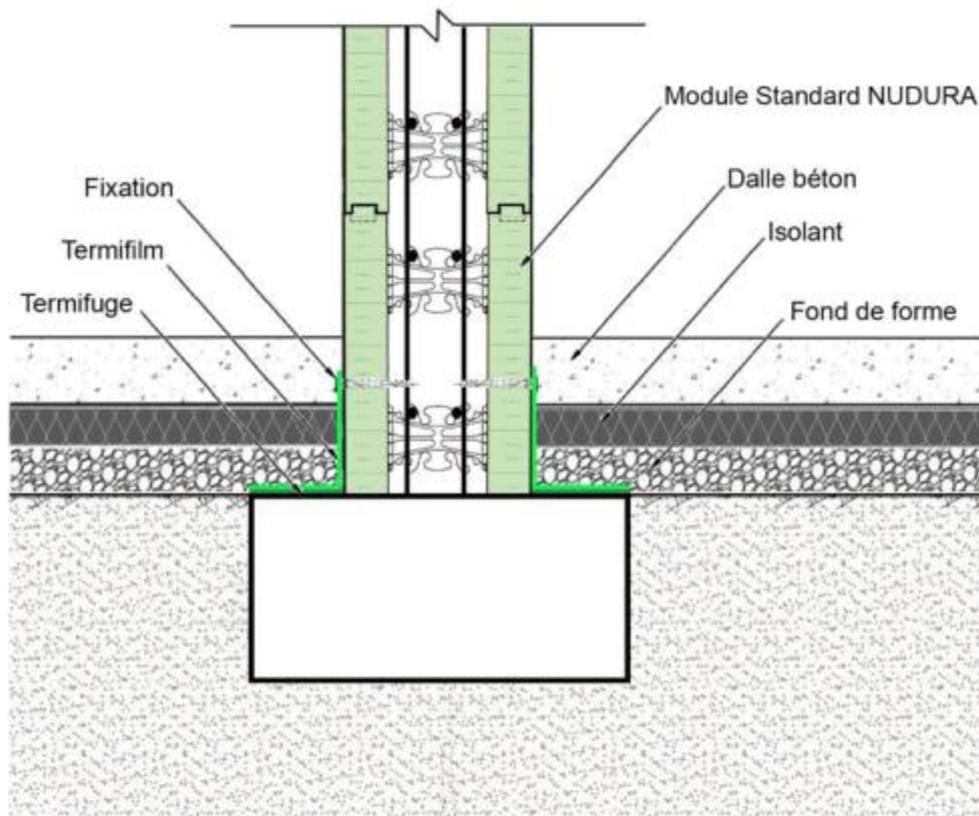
Traitement termite – Refend dallage sur terre-plein isolé et non porté
